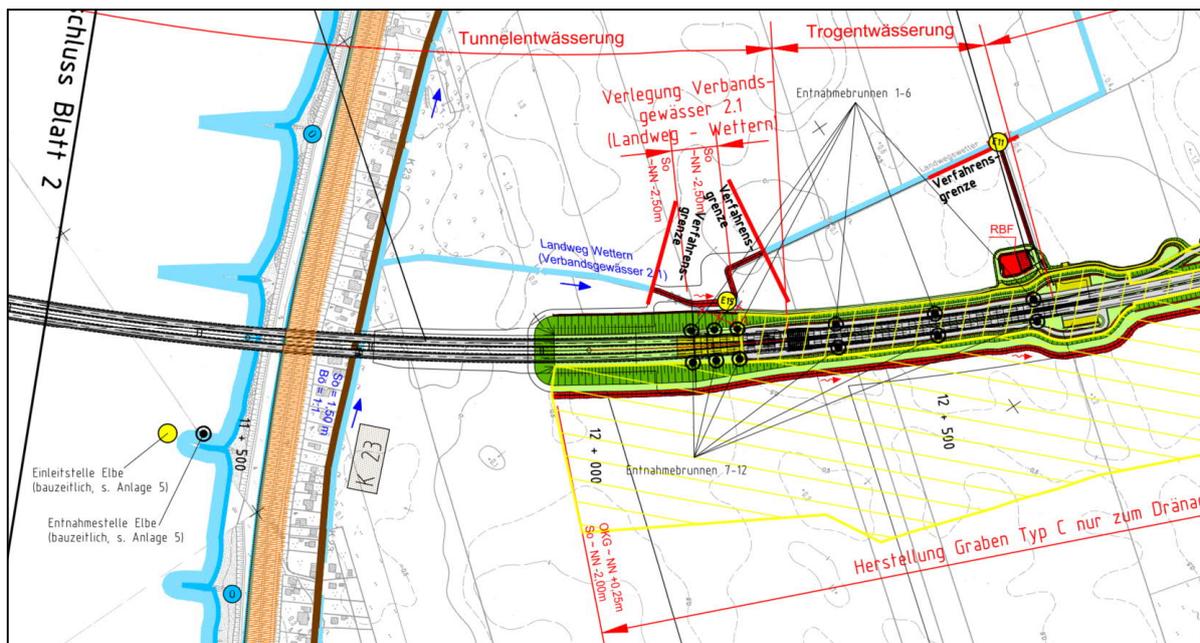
Lage von Trogbauwerk und Tunnelstrecke der A 20, TS 8, zum OWK *Tideelbe* (Ausschnitt Übersichtsplan Wasserwirtschaft, PFU, Unterlage 13)
